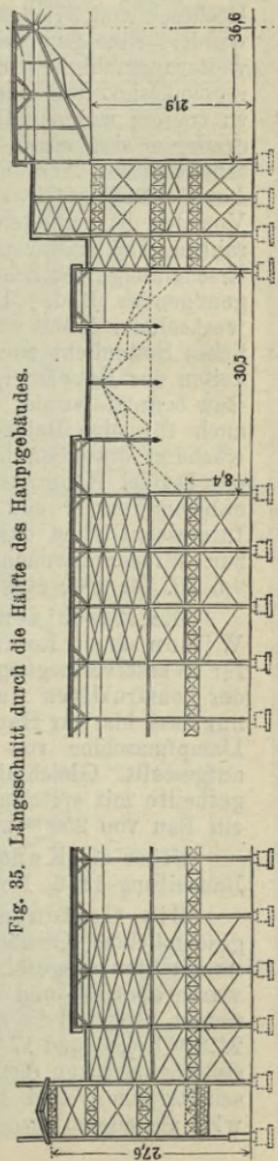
Hauptgebäude der Welt-Ausstellung zu Philadelphia 1876.
